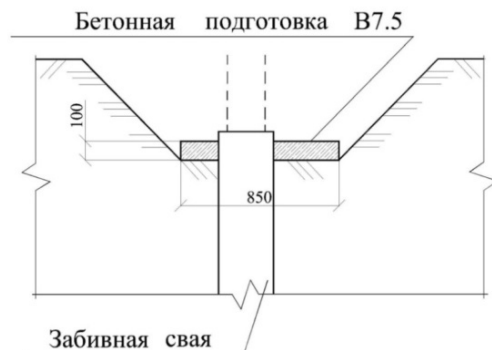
Сечение бетонной подготовки 850 мм 1–1
